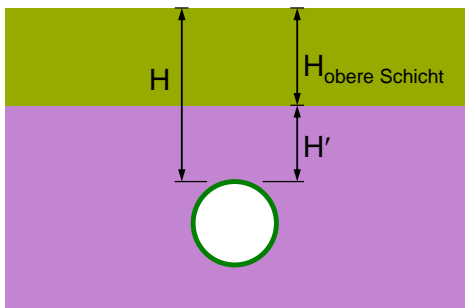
Überdeckung eines Tunnels mit geschichtetem Untergrund
